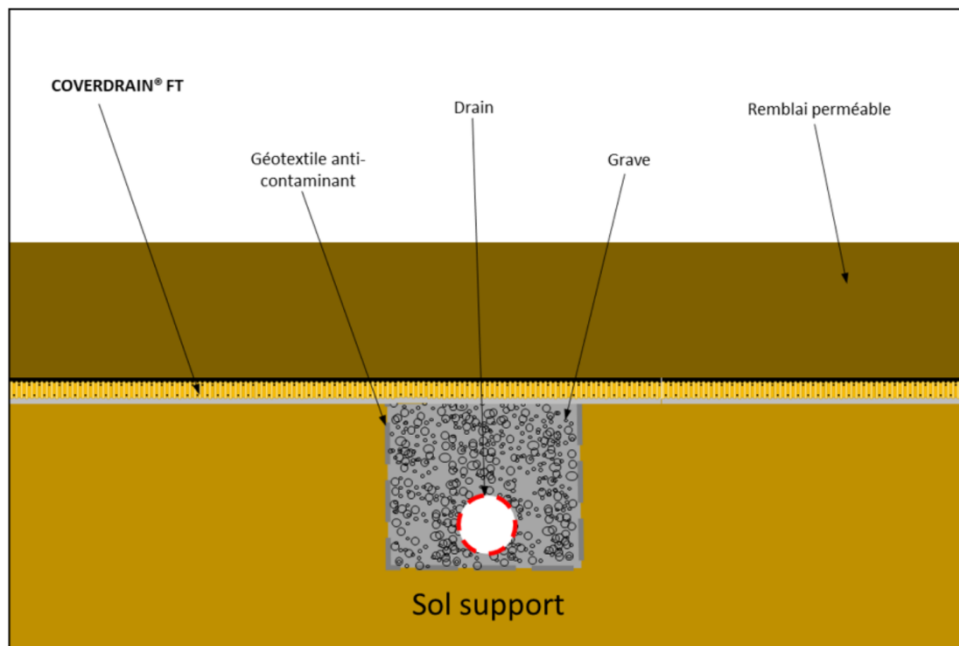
Jonction COVERDRAIN® FT / Tranchée drainante
